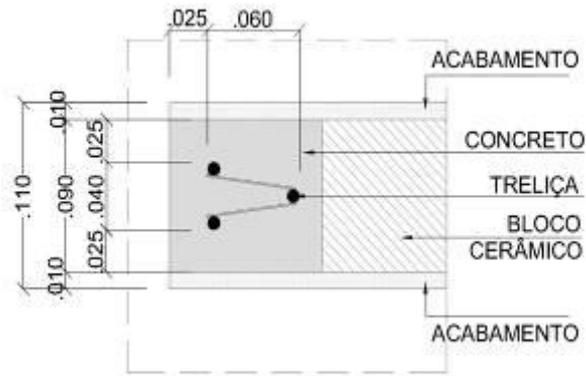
Detalhe das treliças colocadas no perímetro dos painéis de 110mm (sem escala)
